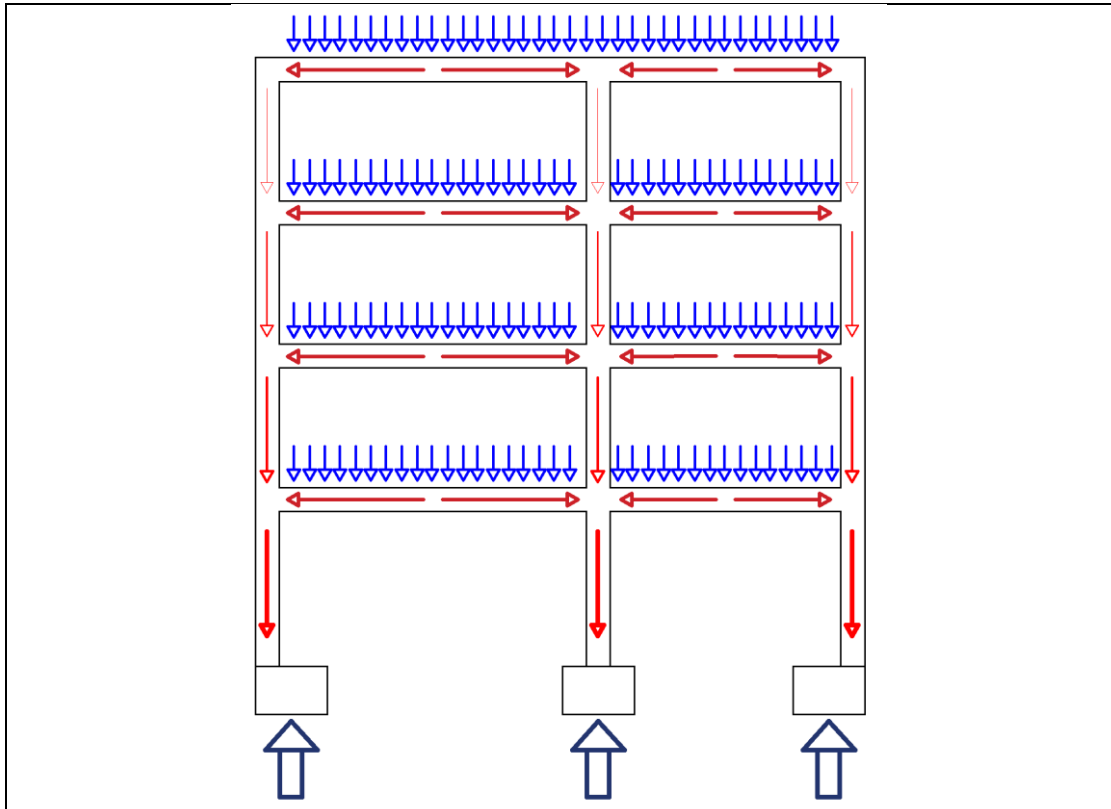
Camino de cargas de pórtico de concreto armado (vista en elevación).
